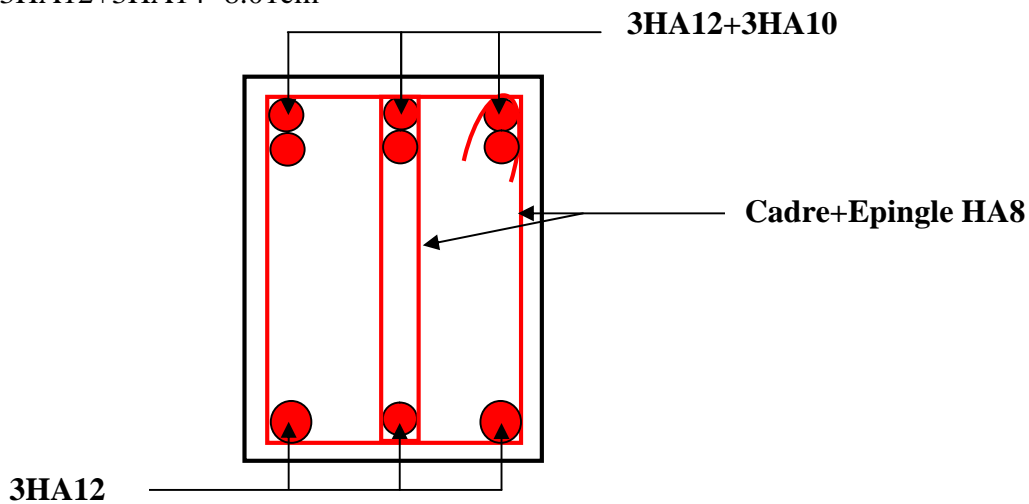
schéma de ferrailage de la poutre de chaînage coté balcon
